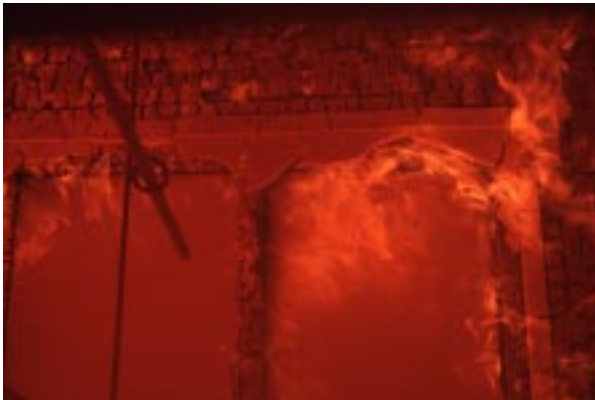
Foto Nr. 14 nach 65 Min.:
